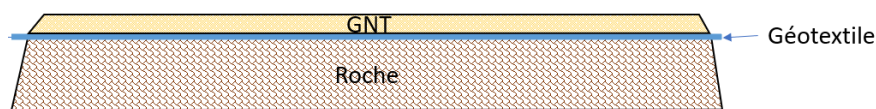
Schéma du type de piste projetée sur le secteur de projet
